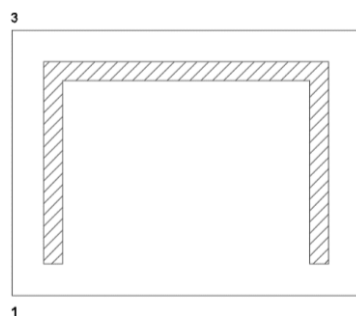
Esquema para determinación de esfuerzos – zapata aislada
